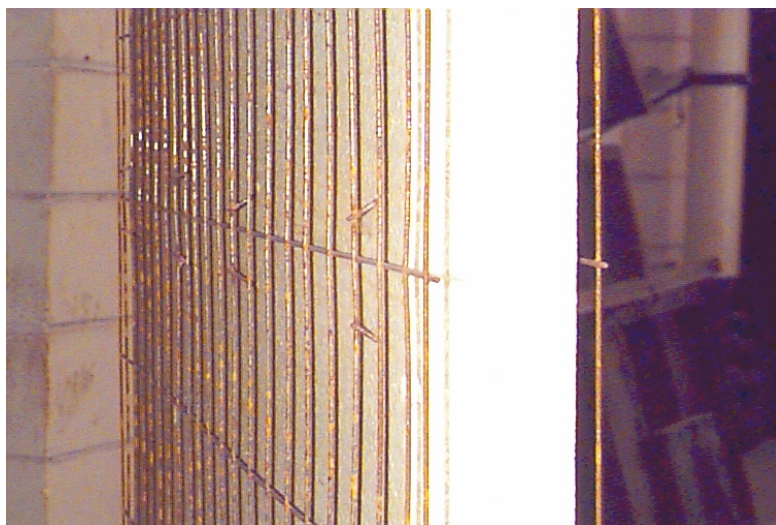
Detalhe do pré-painel (EPS + tela soldada)
